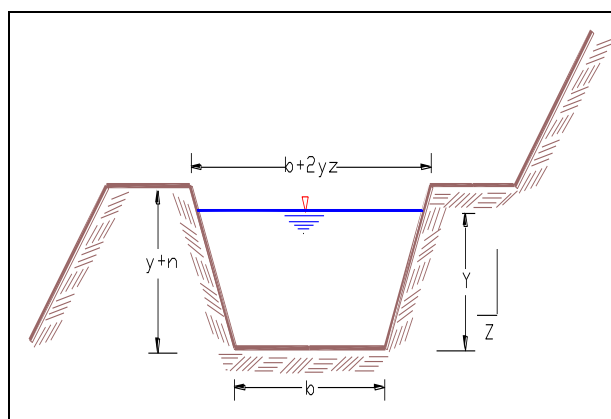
Detalle de cunetas de drenaje y coronación.
